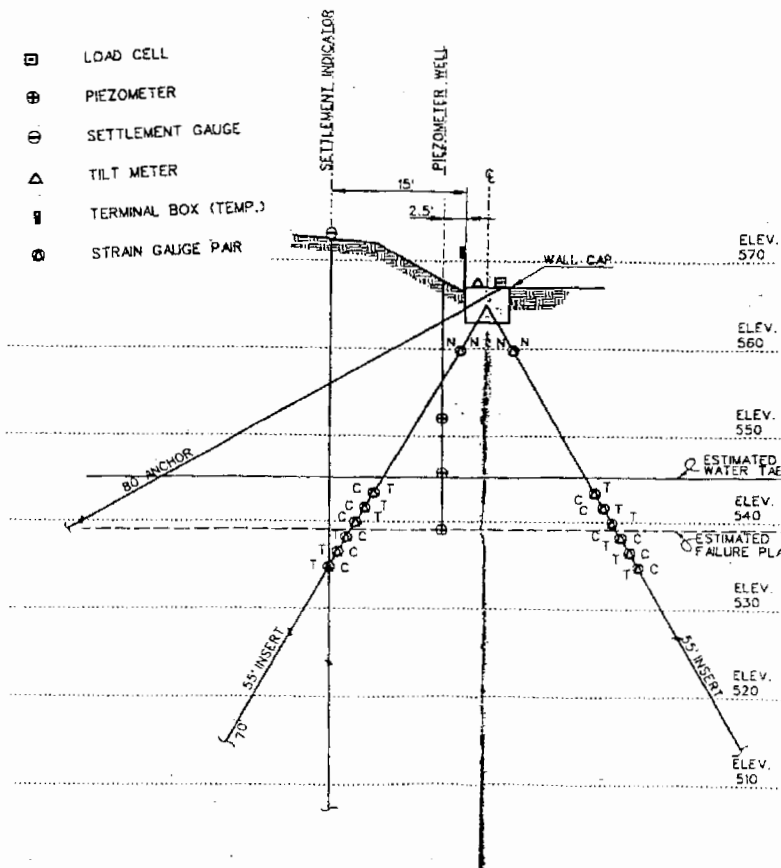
Coupe du mur instrumenté à la section 1 + 70.
